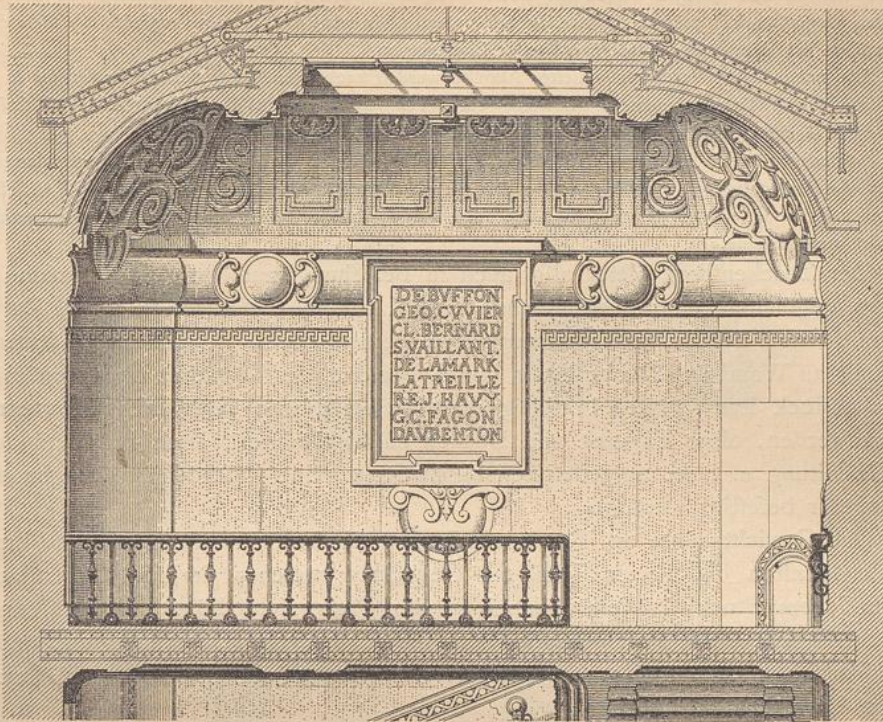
<sup>128)</sup> zeigt ein Deckengefims mit grofser Hohlkehle in Gypsgufs unter dem Deckenlicht eines Treppenhaufes. Das Deckenlicht ift von I-Trägern eingefafft, die an die Dach-Construction hinaufgehängt find; auf deren Unterflansche legen fich bogenförmige I-Eifen, mit Abftänden von etwa 60<sup>cm</sup> und mit dem Fußende in der Mauer verfpant. Zwischen diefe I-Eifen find fchwache, wagrechte Stäbe eingefetzt, und über den fo gebildeten cylindrischen Rost ift das Deckengefims auf Hohlformen in Gyps gegoffen worden. Das Verfahren ift im Wefentlichen die Uebertragung desjenigen, welches in Paris für wagrechte, mit Füllungen
